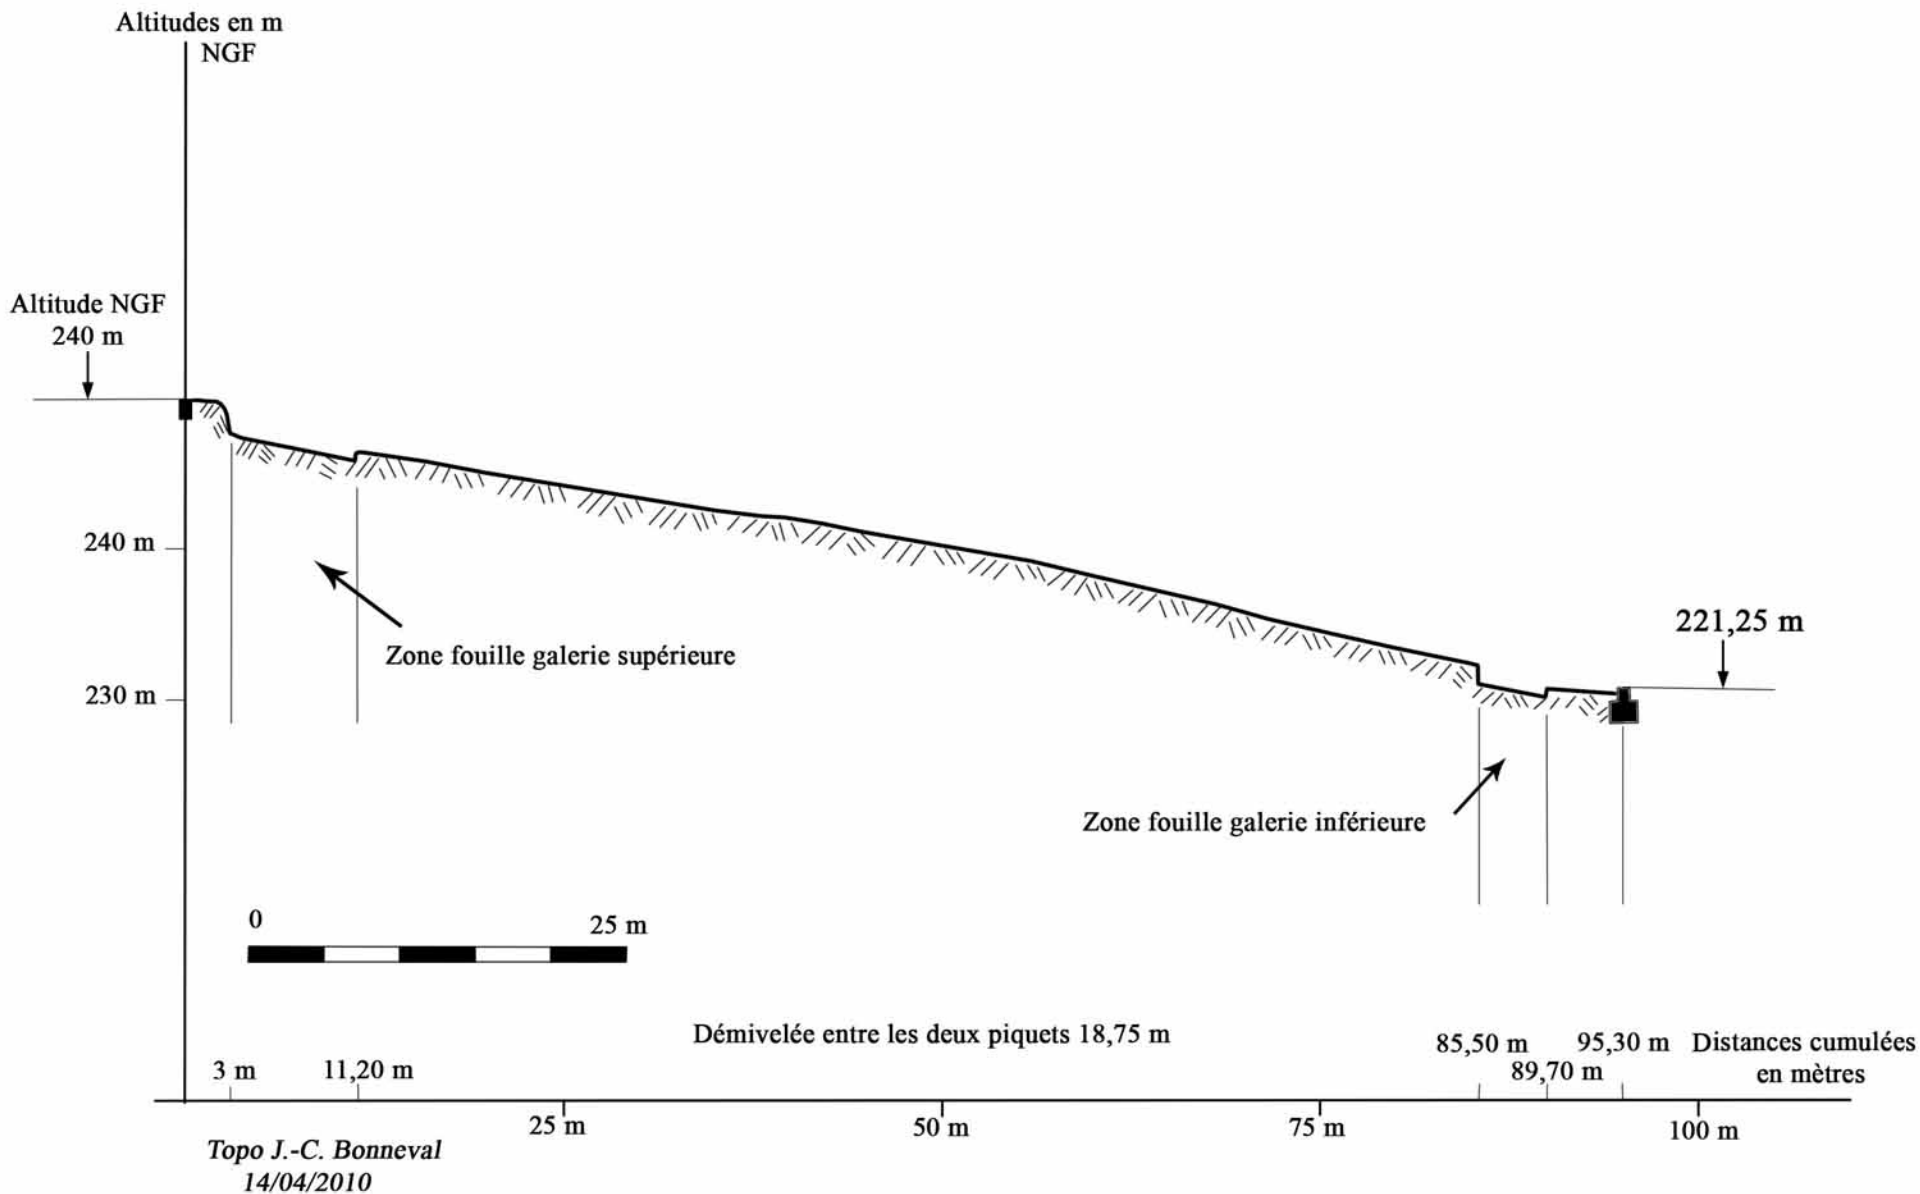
Galerie drainante du Puy-d'Issolud (Vayrac) - Profil en long.
